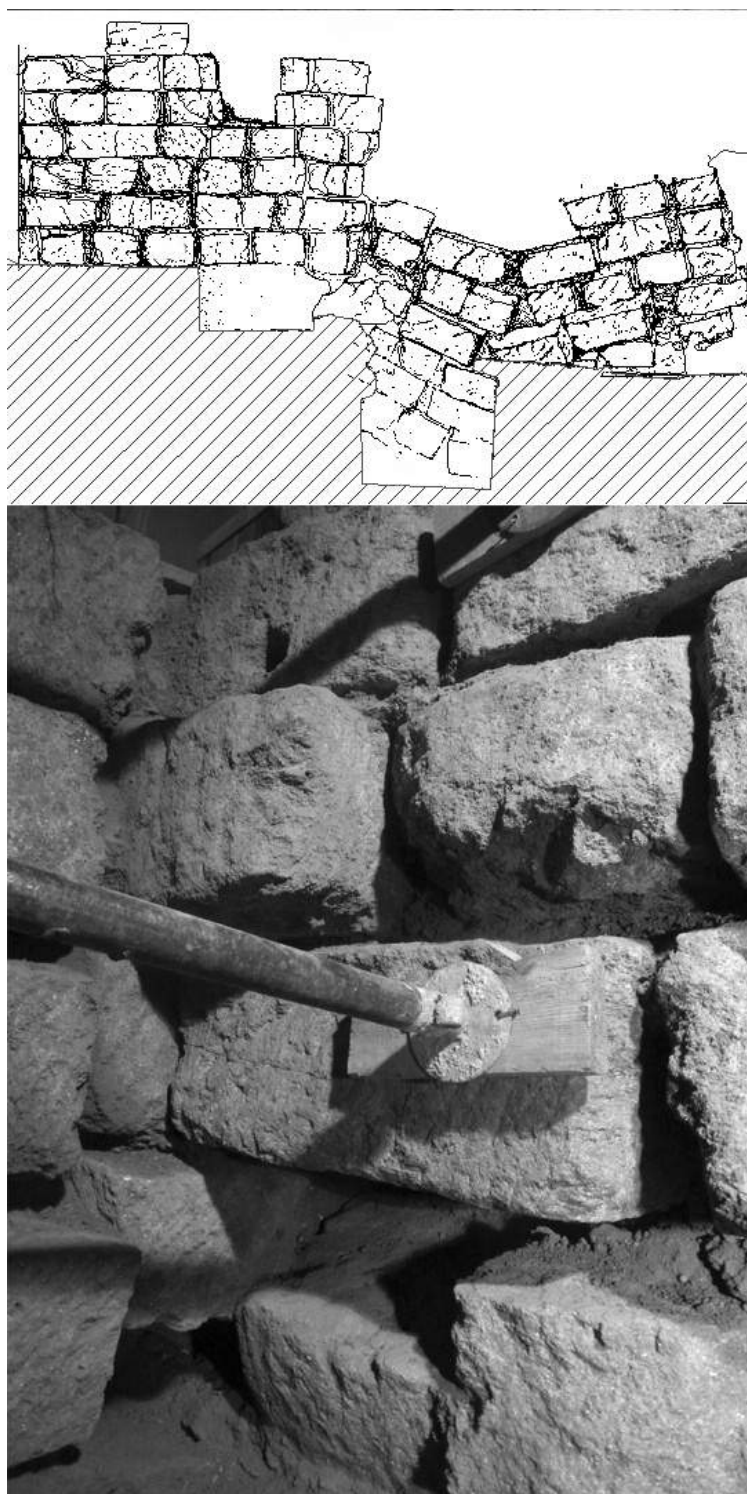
DISSESTI NELLA MURATURA IN OPERA QUADRATA (IN ALTO PROSPETTO DEL MURO A; IN BASSO FOTO DI DETTAGLIO DELL'ANGOLO INTERNO TRA I MURI B E C).
